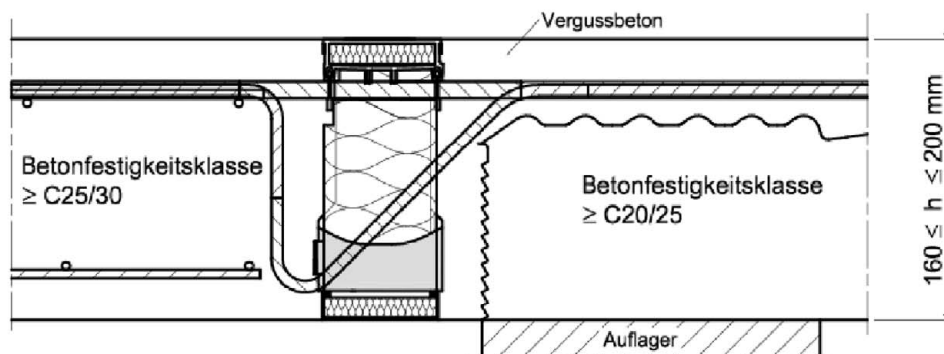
Beispiel Schöck Isokorb® T Typ K-ID mit Betondrucklager in eingebautem Zustand mit Vergussfuge
